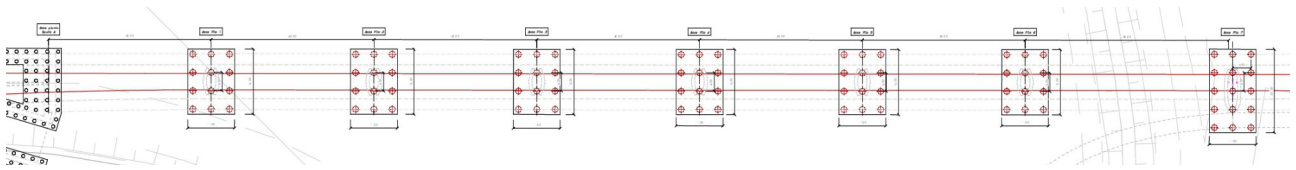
Pianta fondazioni - Ponte a struttura mista acciaio calcestruzzo a doppio binario
